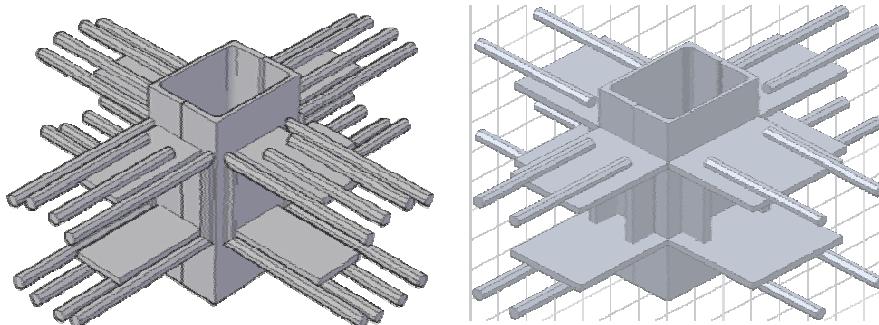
Металеві конструкції безкапітельного вузла з'єднання монолітного безбалкового перекриття з колонами зі швелерів
